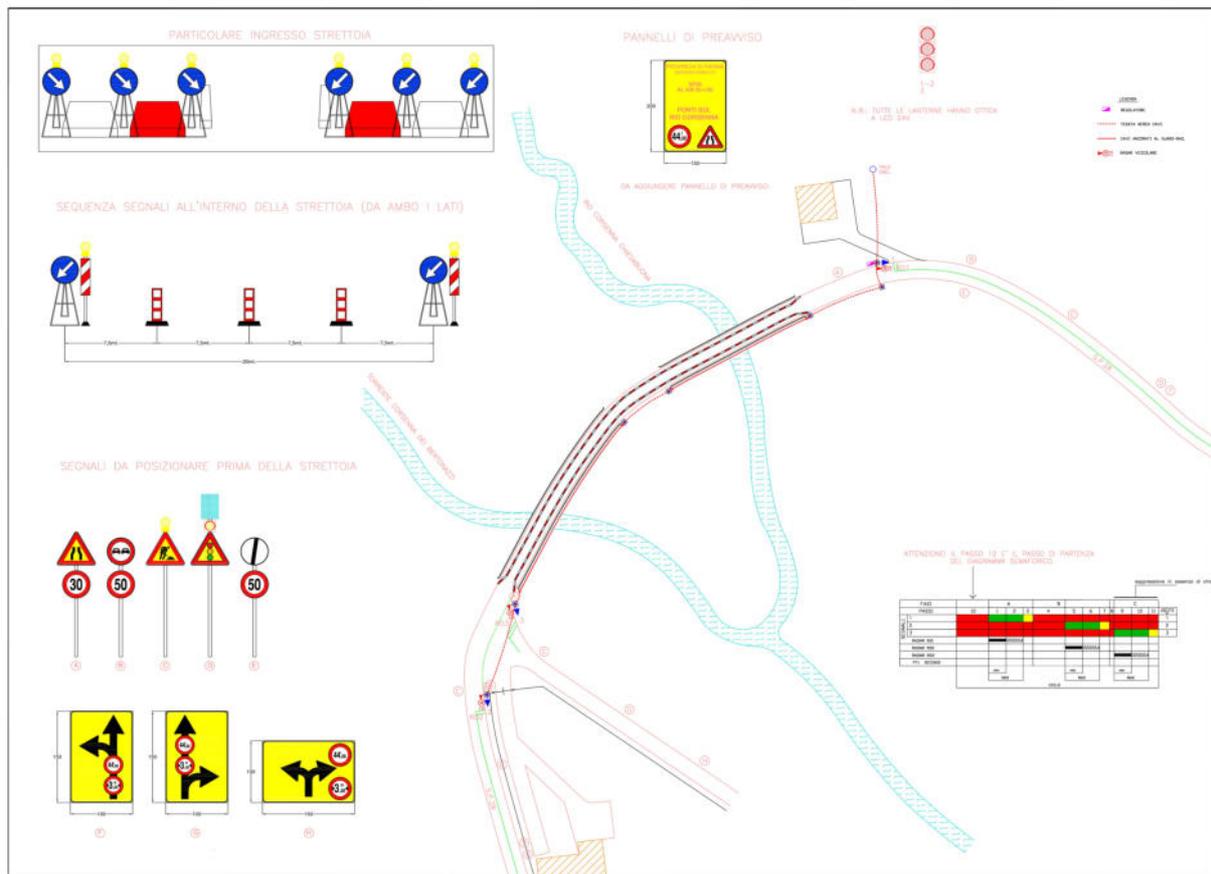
TAV.1: PLANIMETRIA INTERVENTO DEL PONTE SUL TORRENTE CORSENNIA DEI BERTONAZZI E PONTE SUL RIO CORSENNIA CHIESABUONA LUNGO SP28 DI VARSÌ IN LOC. CAVALLARA
